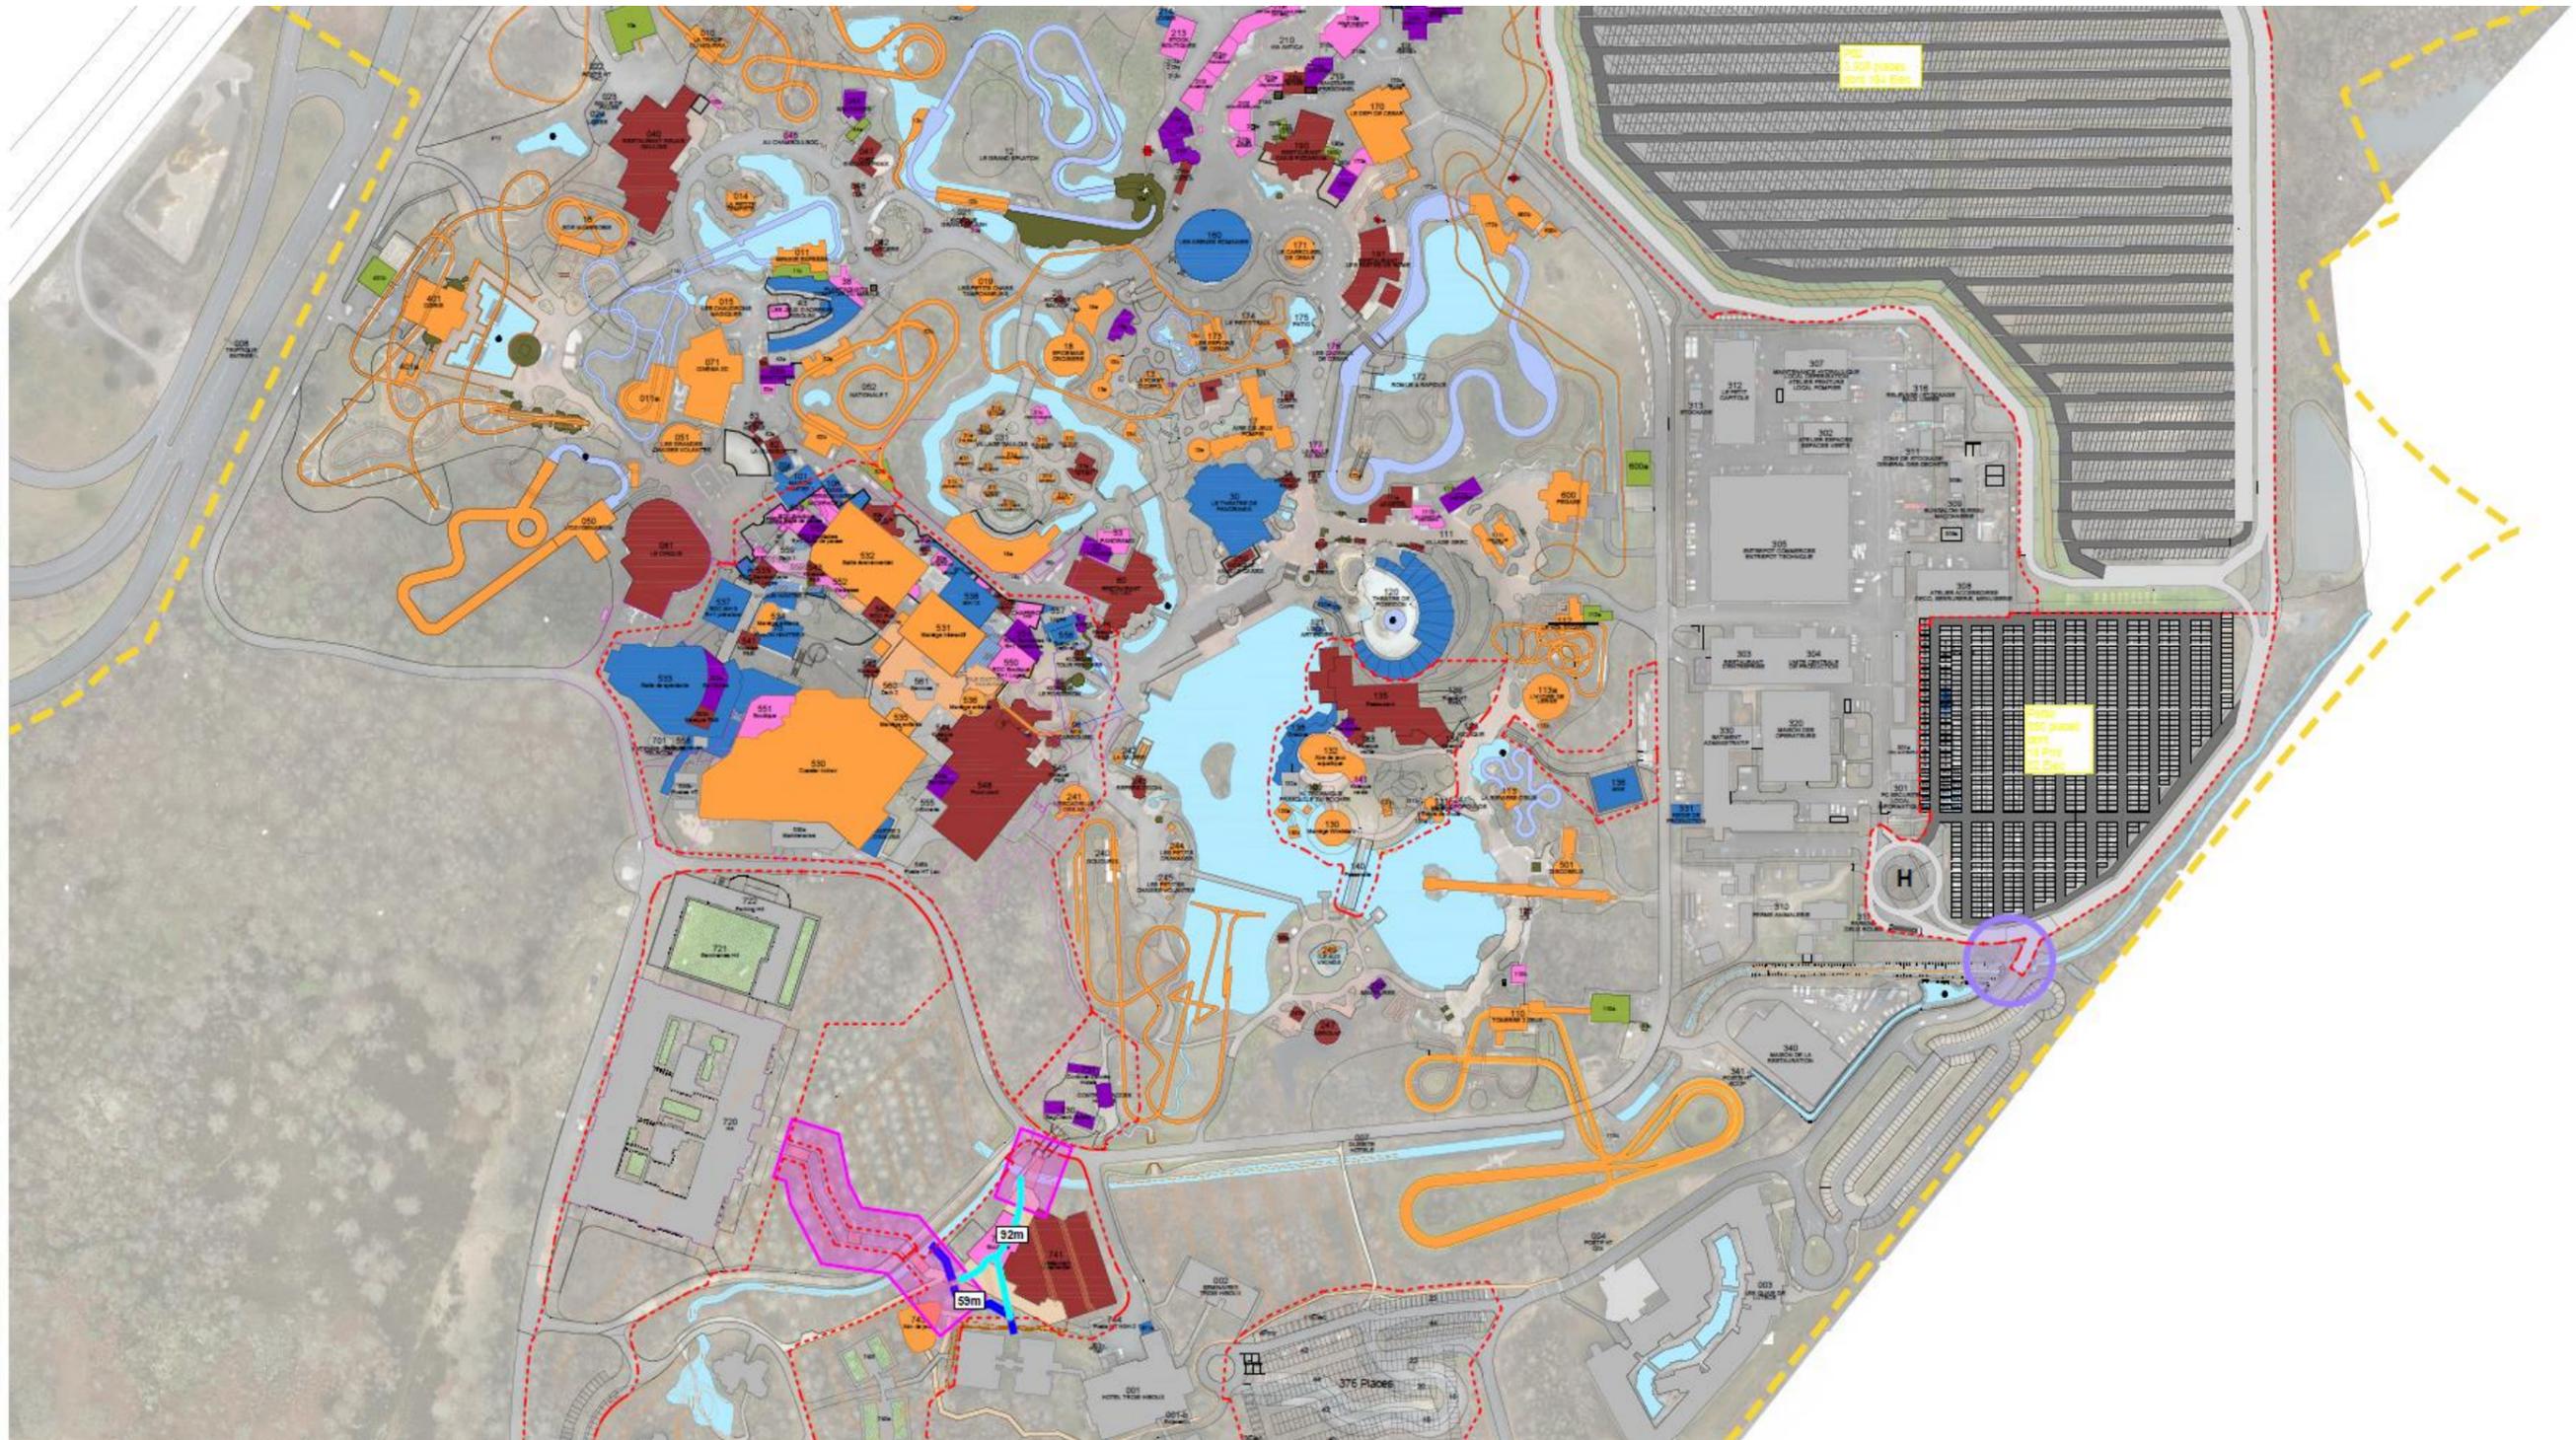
Plan de localisation des ouvrages hydrauliques – Plan 2/3 (Parc Astérix)
